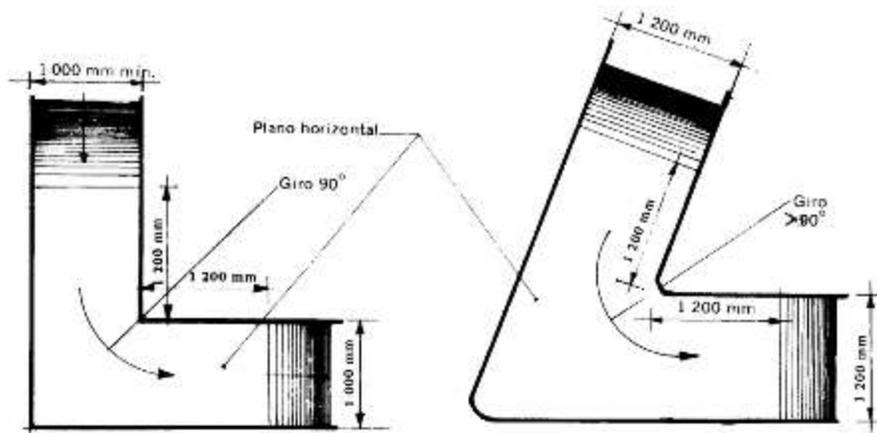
Tipos de rampas fijas con ángulo de 90° y ángulo recto
